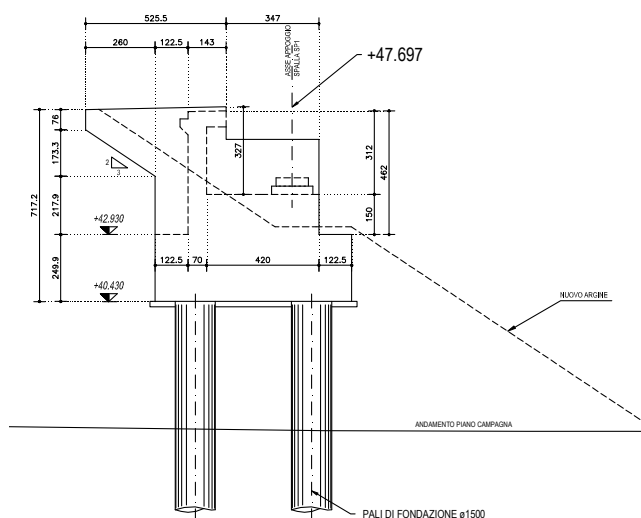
Sezione longitudinale Spalla lato Parma – Progetto Esecutivo
